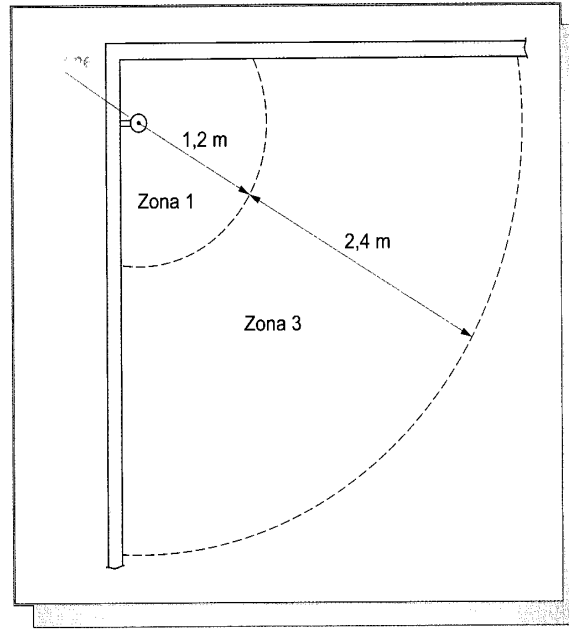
Zone di rispetto in un locale doccia senza piatto doccia, secondo la nuova norma CEI 64-8 (pianta).
